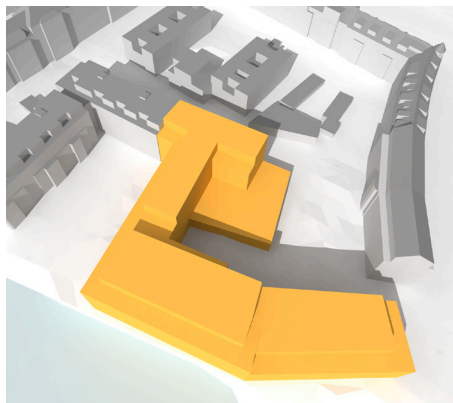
Konservative Bebauung nach gültigem Planrecht
